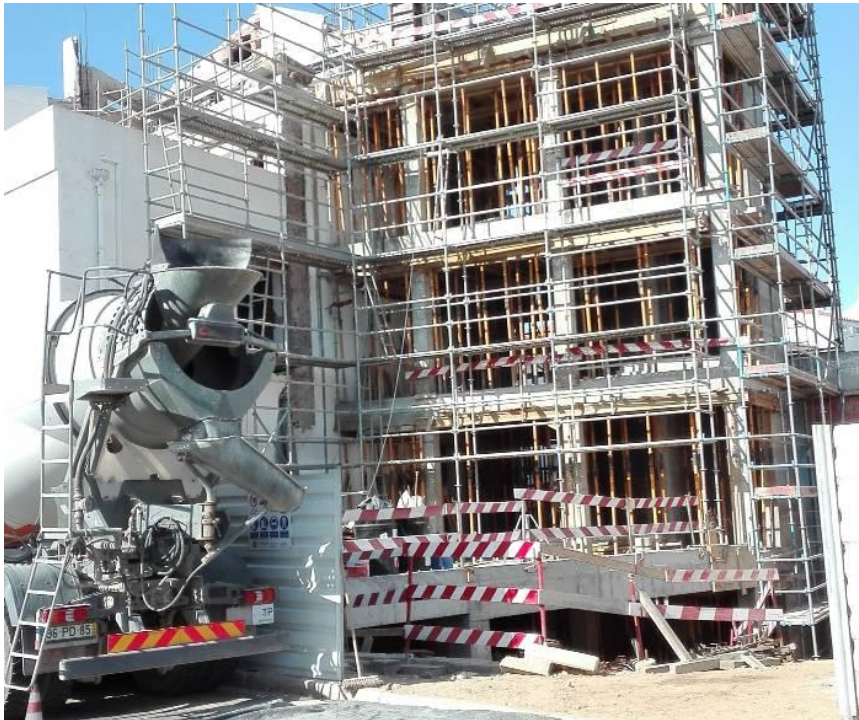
Execução da betonagem da laje e vigas do piso 2
